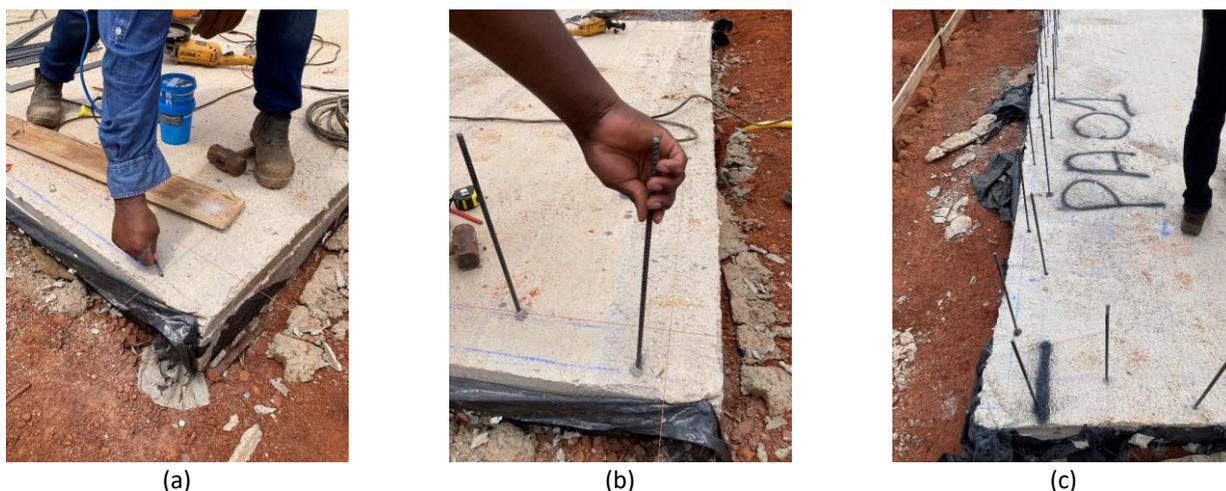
(a) marcação das paredes, (b) fixação das barras de ancoragem de aço galvanizado e (c) barras ancoradas à fundação
